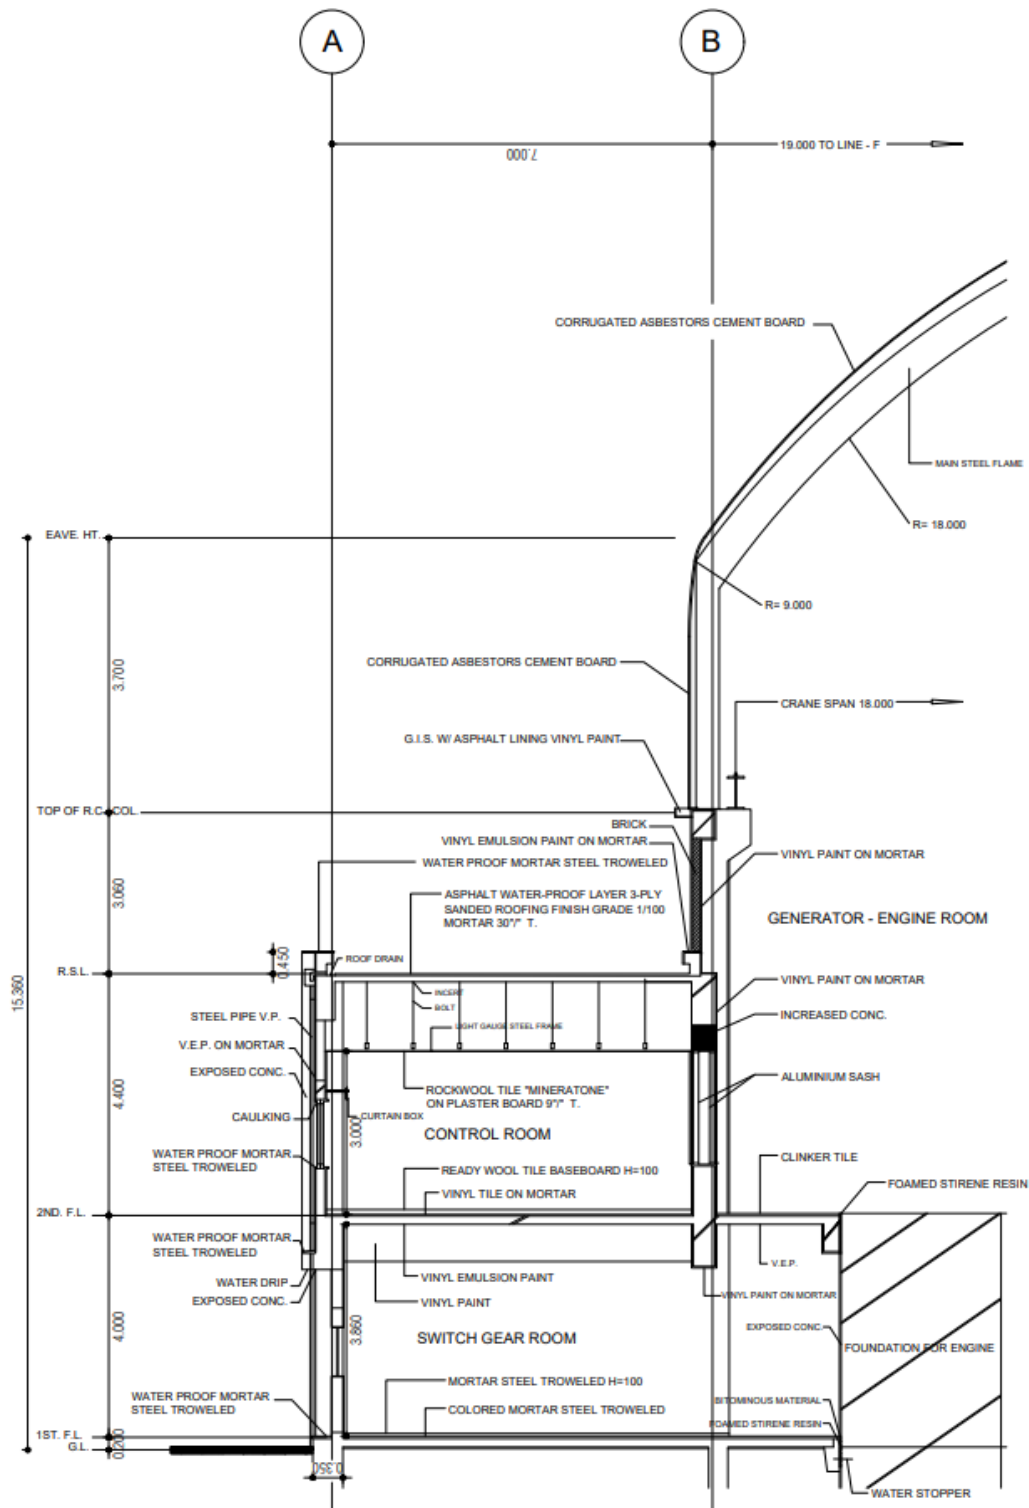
planos de los cortes de la casa de maquinas – AutoCAD
